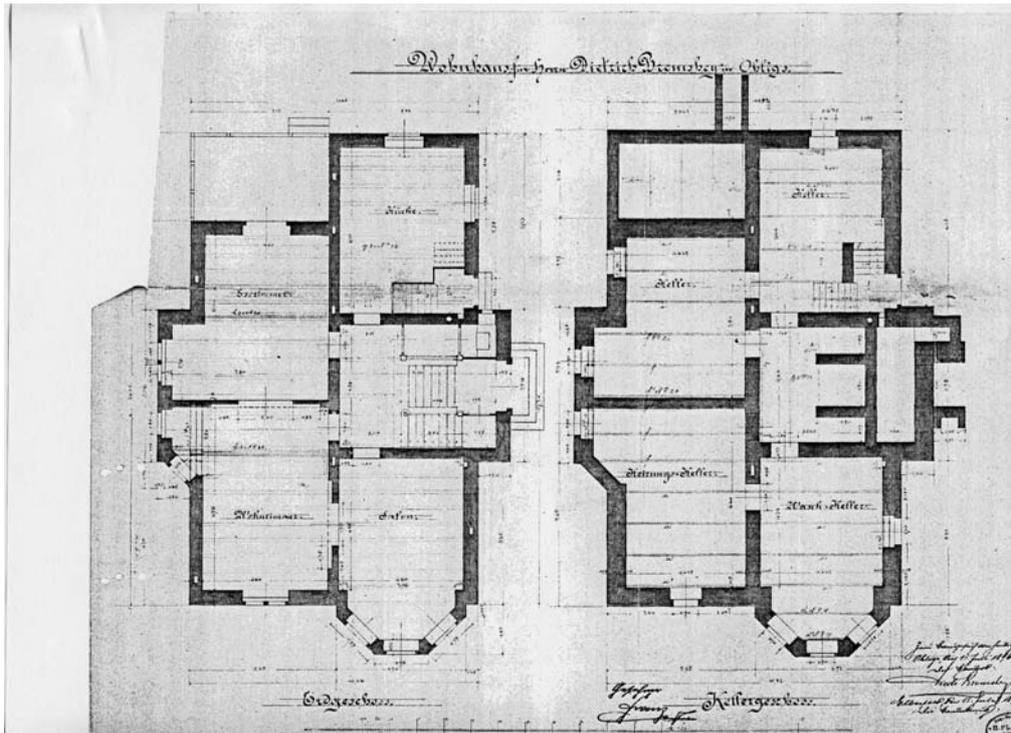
H. Plange, Grundriss Erdgeschoss (links) und Kellergeschoss, 1896
